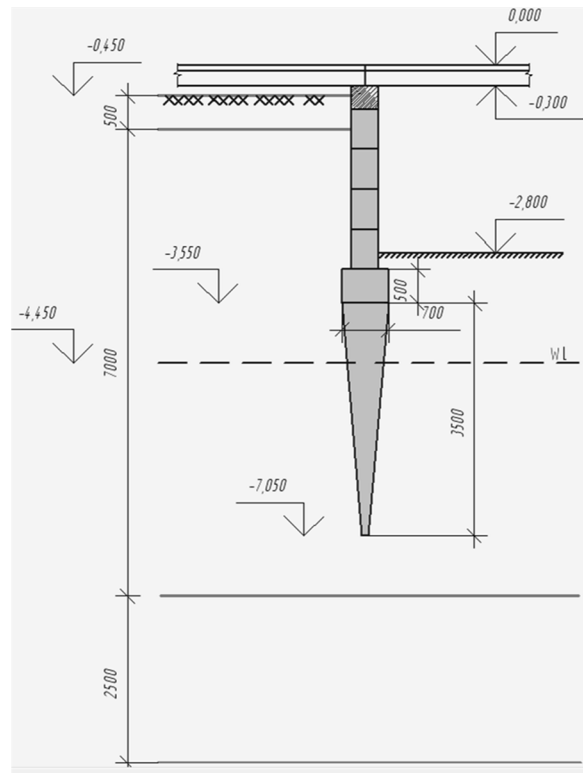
Схема розташування пірамідальної палі у ґрунті
